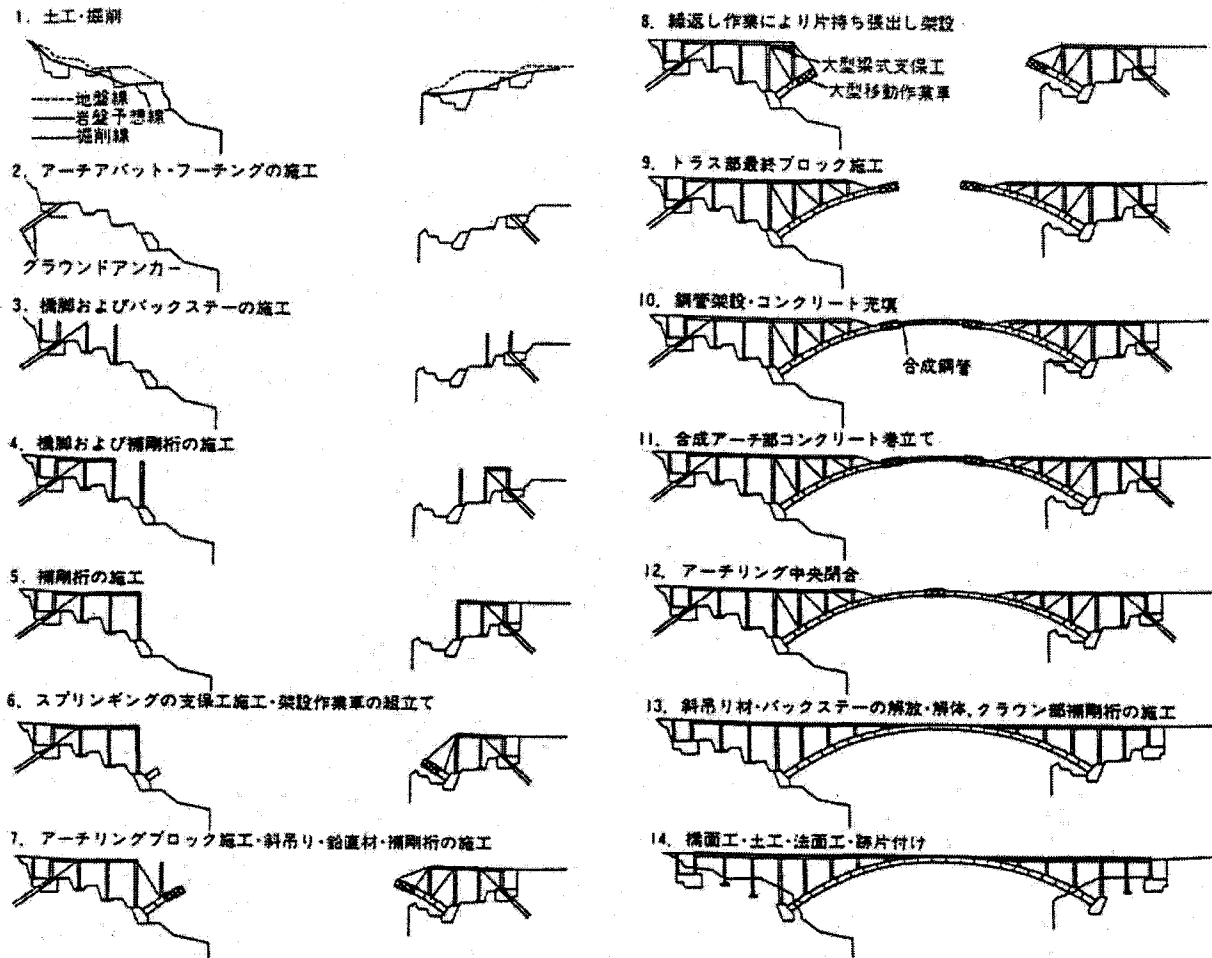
青葉大橋の施工順序¹⁷⁾
